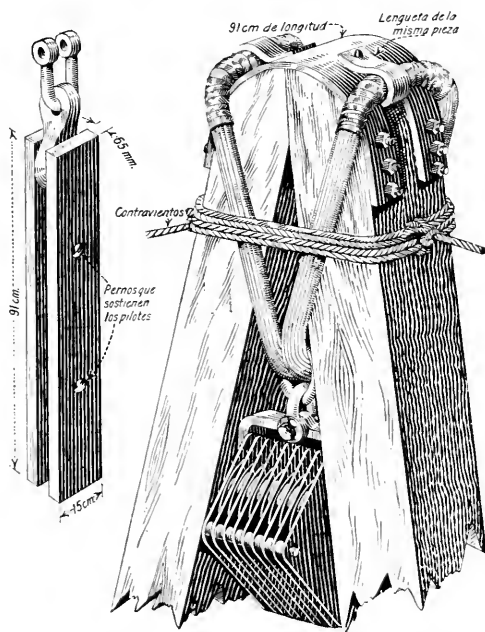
DETALLE DE APAREJO PARA SACAR PILOTES
